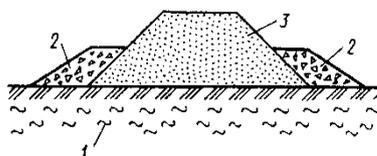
Увеличение устойчивости насыпи на слабых грунтах методом боковой пригрузки:
